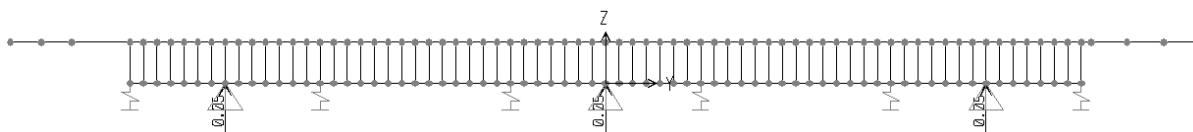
Traverso - Condizione "Sollevamento\_(Q)": spostamento impresso.
